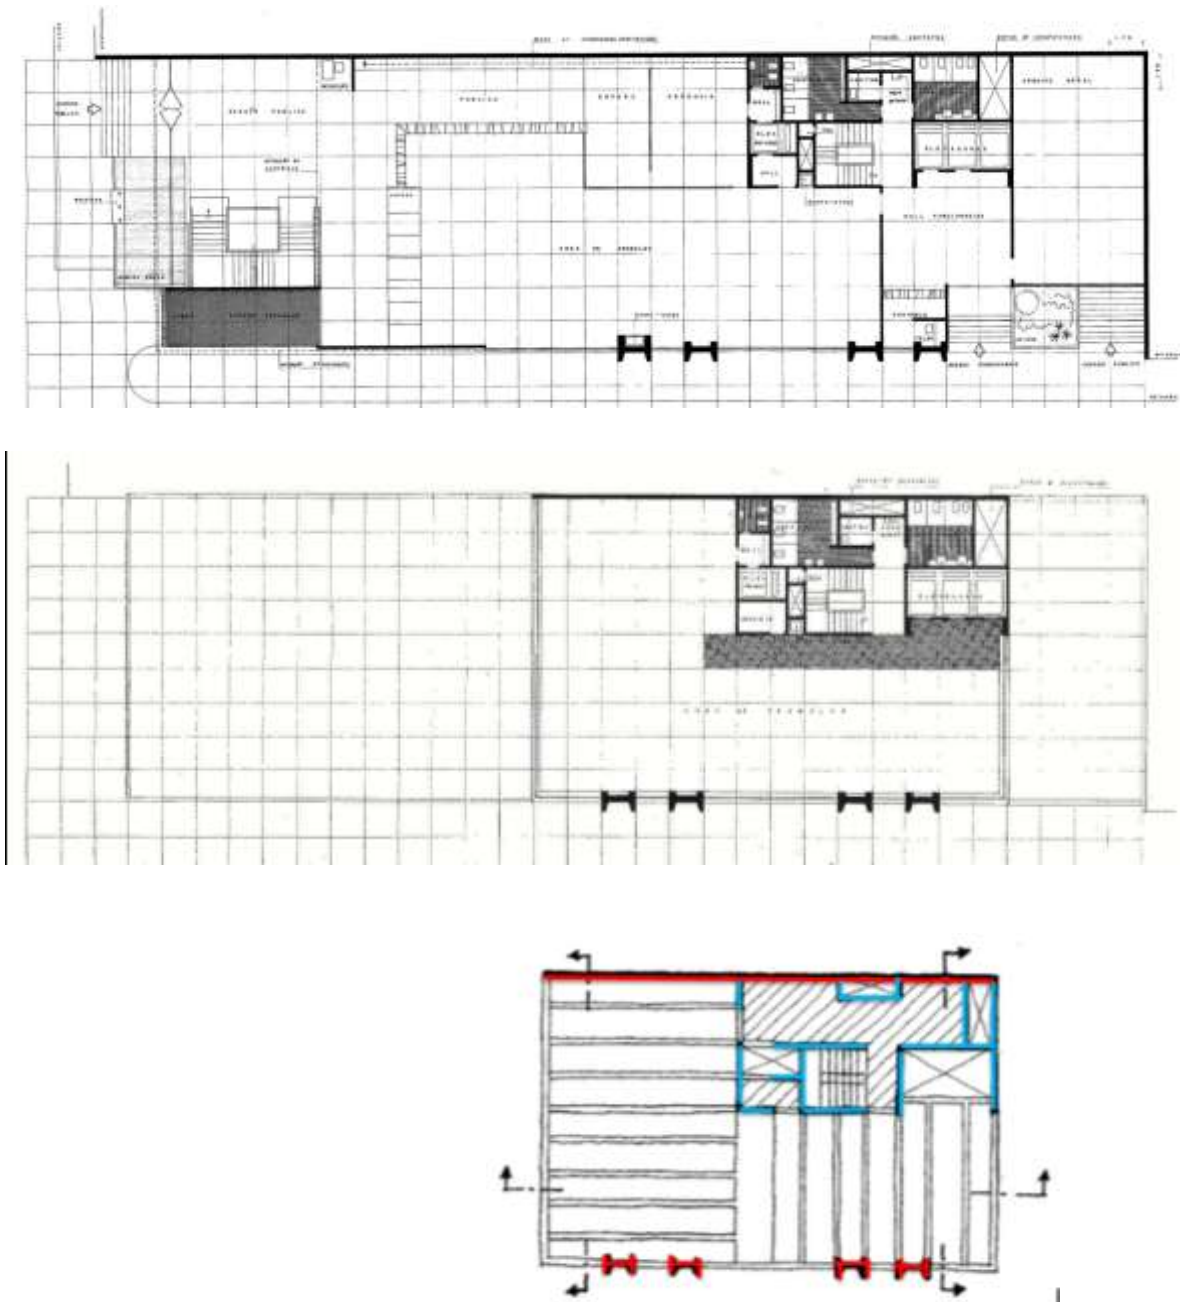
Planta do térreo (em cima) e do pavimento tipo (centro). O desenho colorido ilustra em vermelho o sistema estrutural de paredes portantes e pilares, em branco as vigas e em azul as vedações dos serviços
